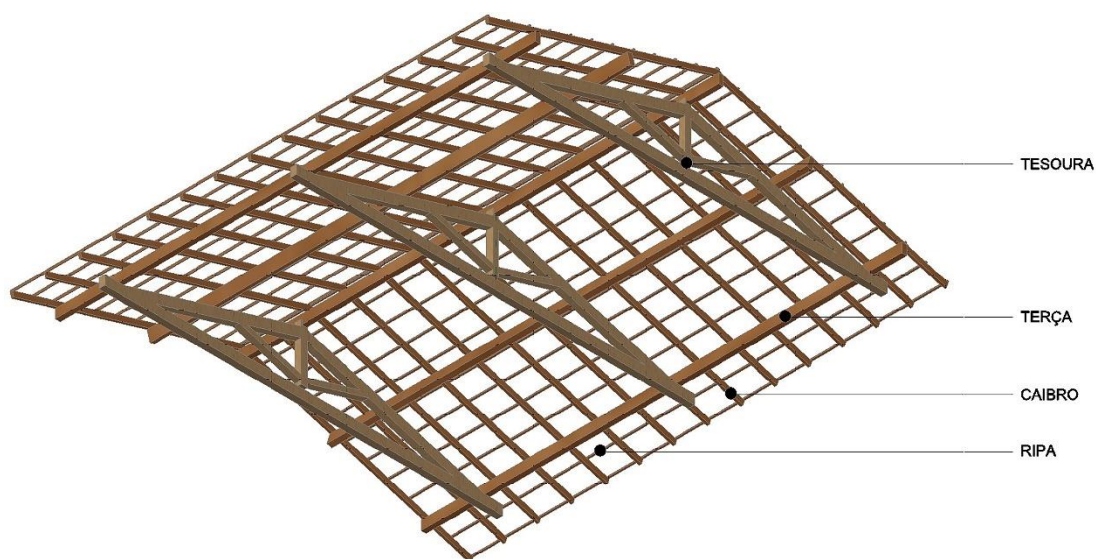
Modelo da estrutura de madeira de um telhado (vista inferior). Fonte: autor
